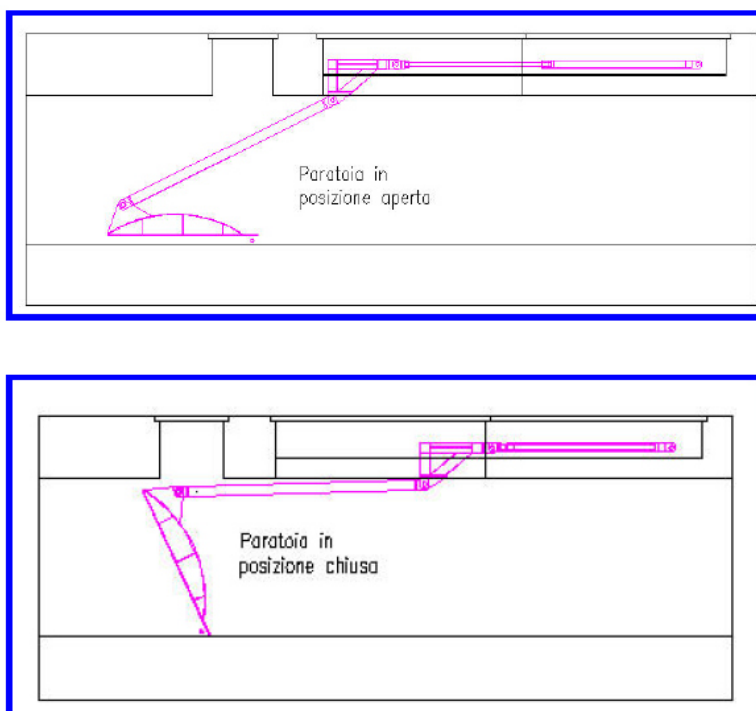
Posizionamenti possibili della paratoia dell'impianto Sortie
